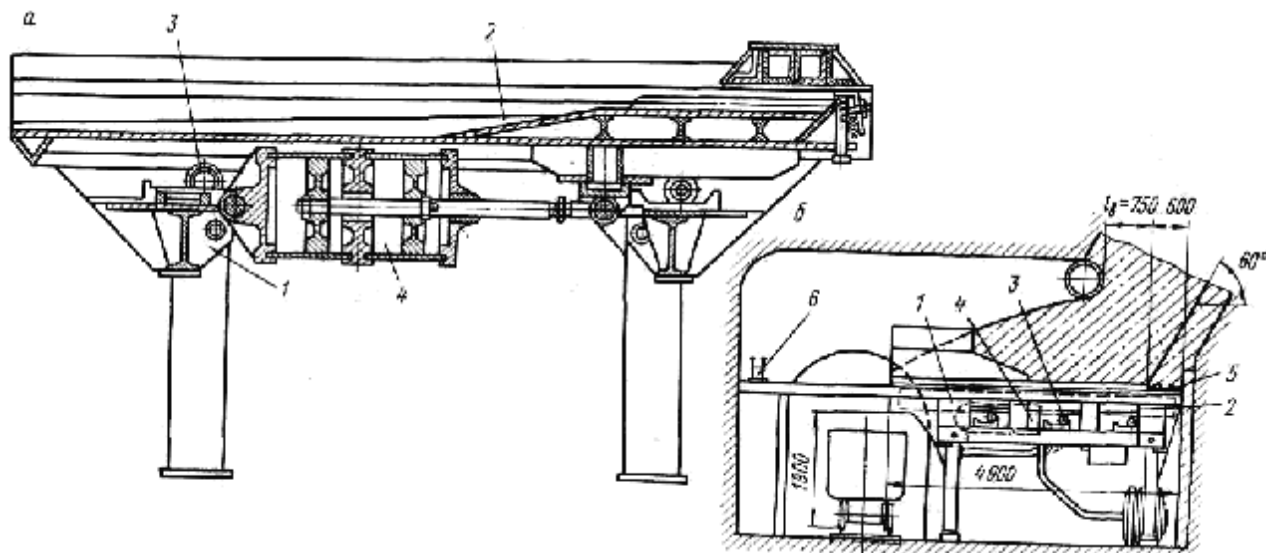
Установка РПУ: а – конструкция установки; б – схема расположения установки под выпускной выработкой
